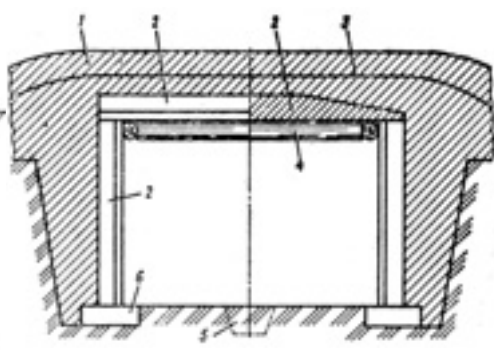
Быстровозводимое убежище со стенами и покрытием из железобетонных плит типа «Ф» для ленточных фундаментов: 1 – насыпной грунт; 2 – плита типа «Ф»; 3 – гидроизоляция; 4 – распорная рама; 5 – дренаж; 6 – опорная плита
